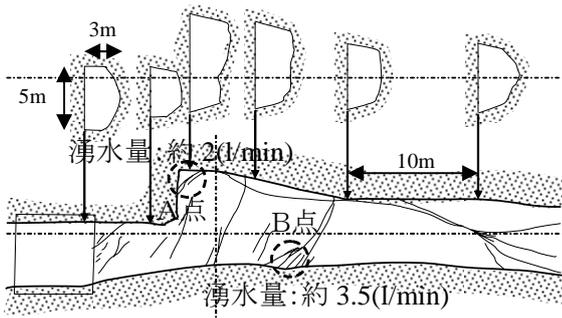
試験ヤードの概要図 (平面、断面、亀裂分布)
